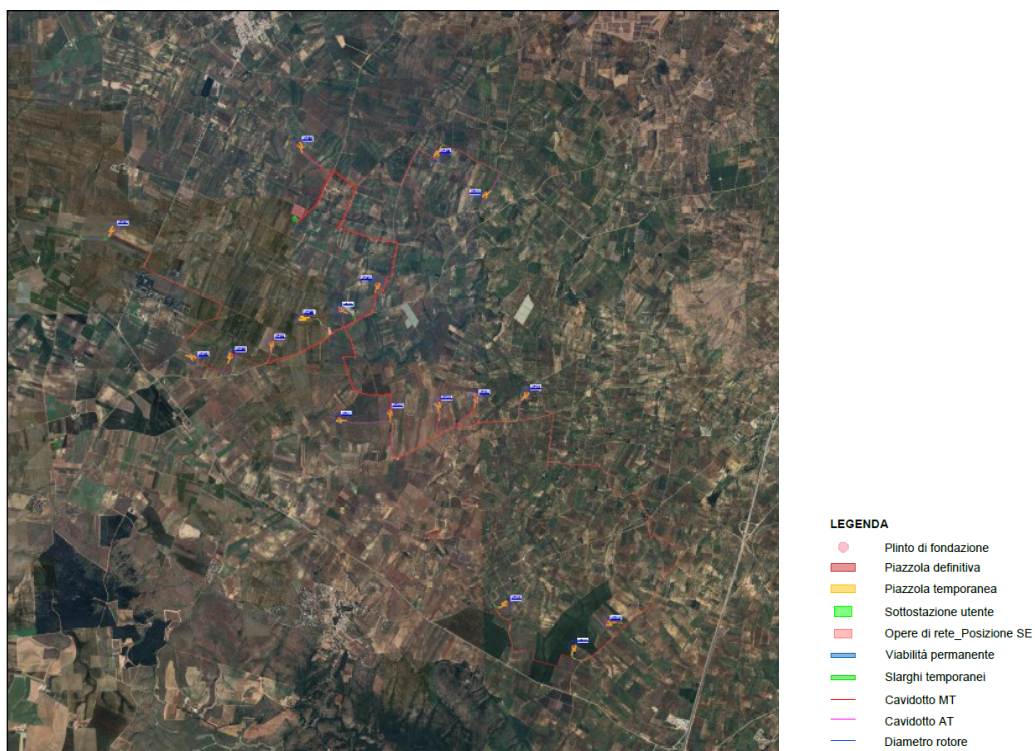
a – Inquadramento su ortofoto. *Fonte: 4.2.9.2.1Layoutdiprogettosuortofoto.pdf
